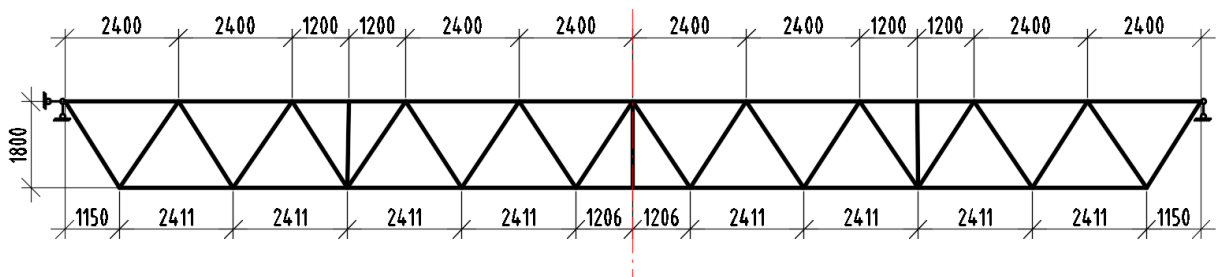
Балочная ферма 2 (грузовой пояс – верхний, узловая нагрузка 3 кН, 1.5 кН)
